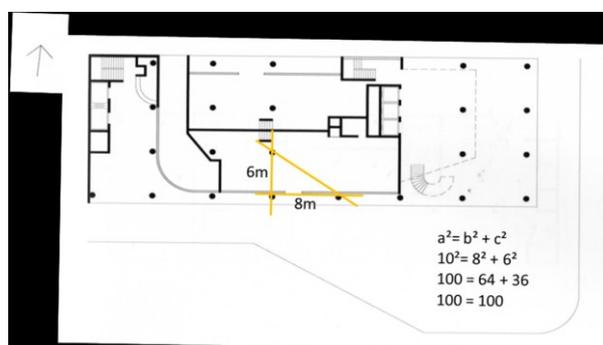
IRB, planta do térreo e triângulo pitagórico 3-4-5 para posicionamento dos pilares. Diagrama e cálculos da autora adaptado na planta existente em SOUZA (2014, página 179), Nov. 2017.
